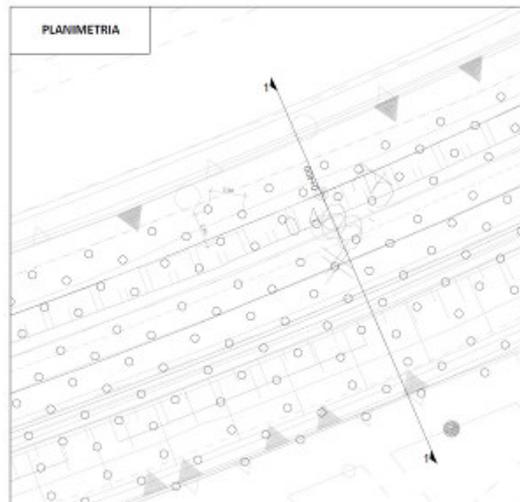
Esempio pianta tipo con colonne di deep-mixing
